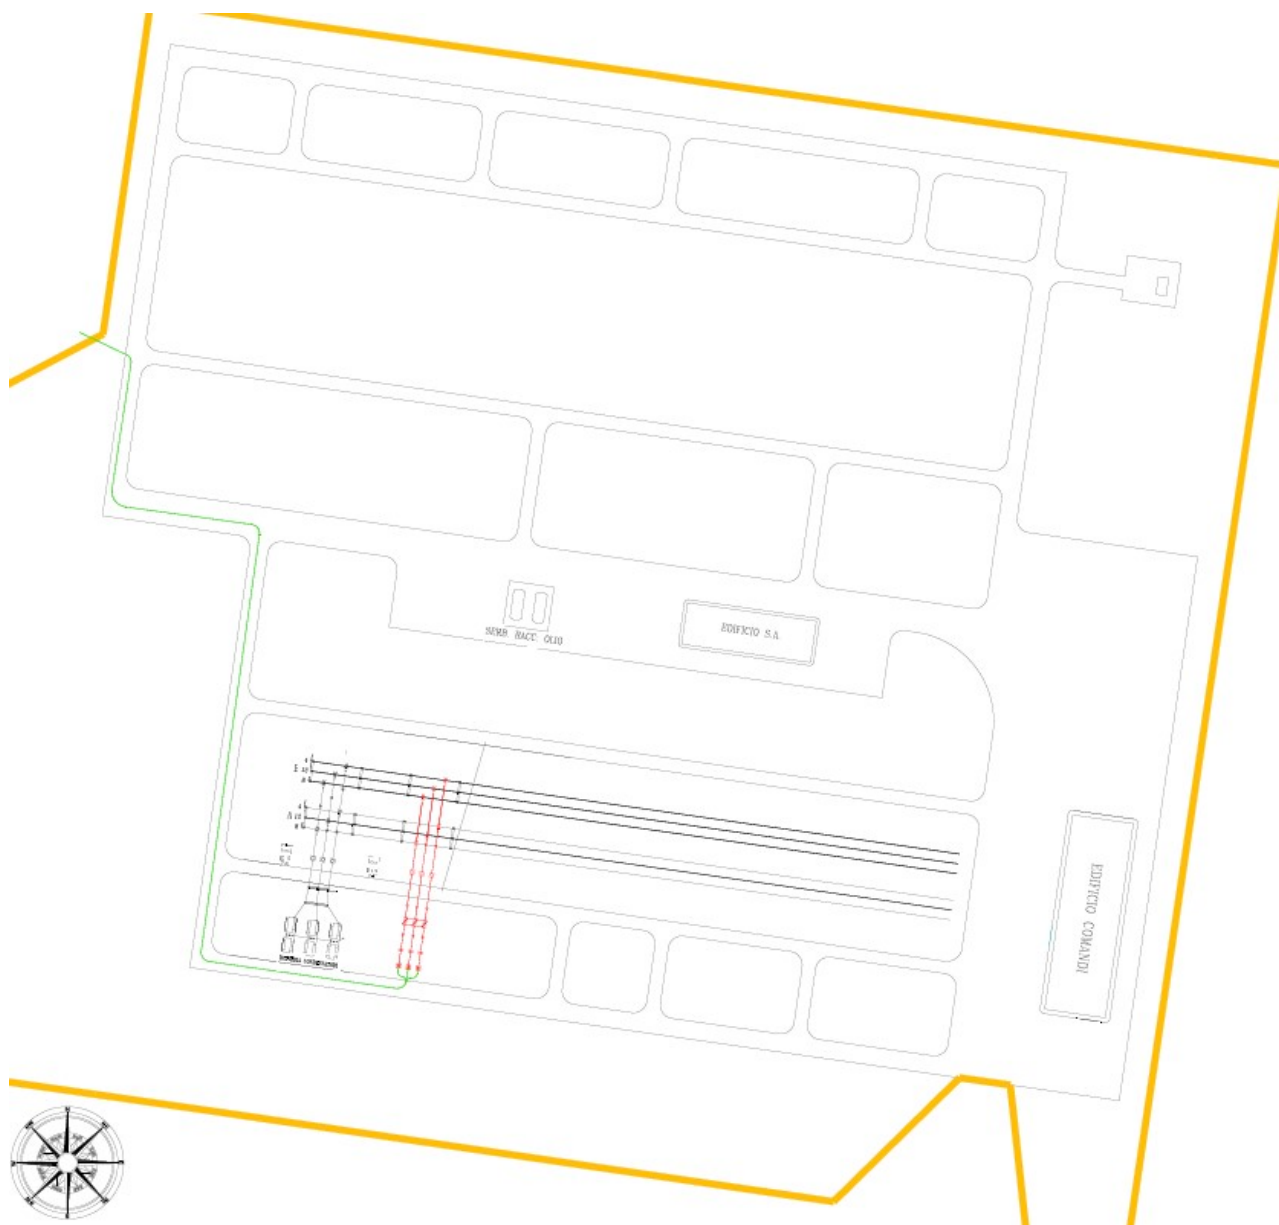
planimetria elettromeccanica nuovo stallo in stazione elettrica esistente
